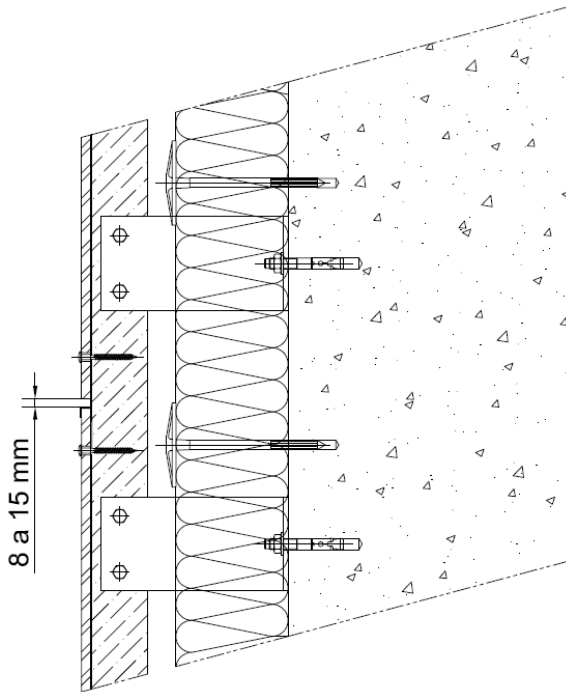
Sección vertical. Junta horizontal entre paneles con perfil auxiliar tipo "silla".
